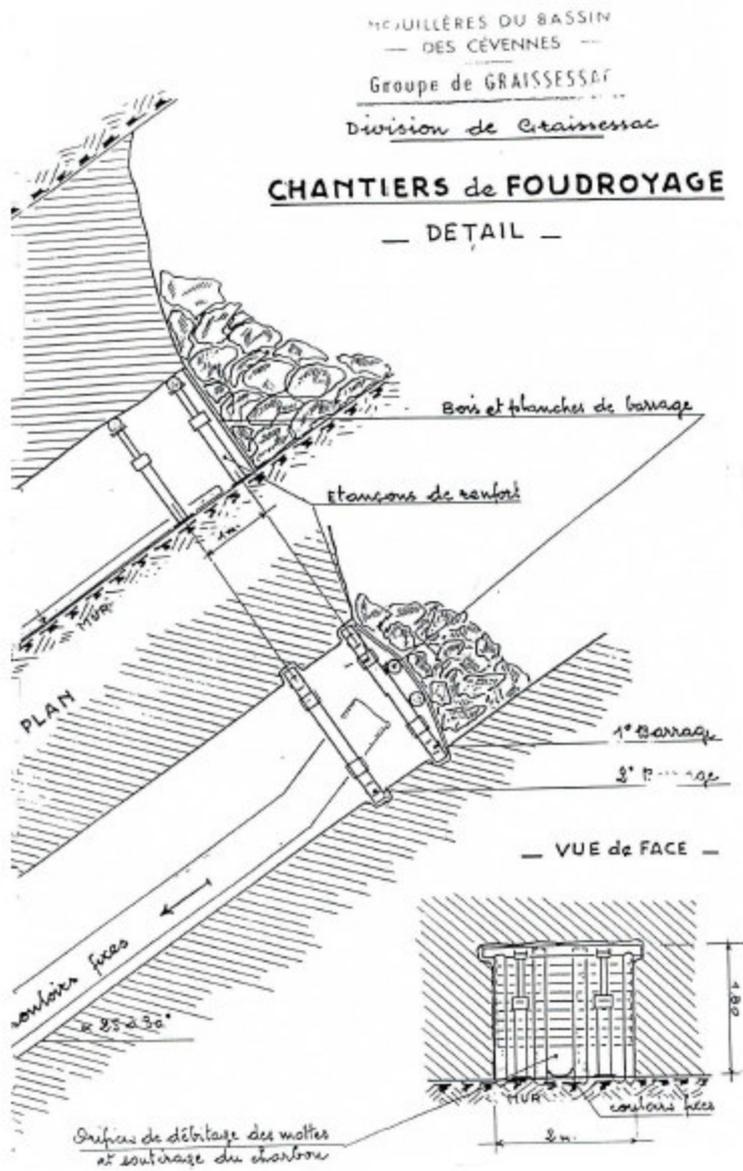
Schéma d'un chantier de foudroyage par sous niveaux
